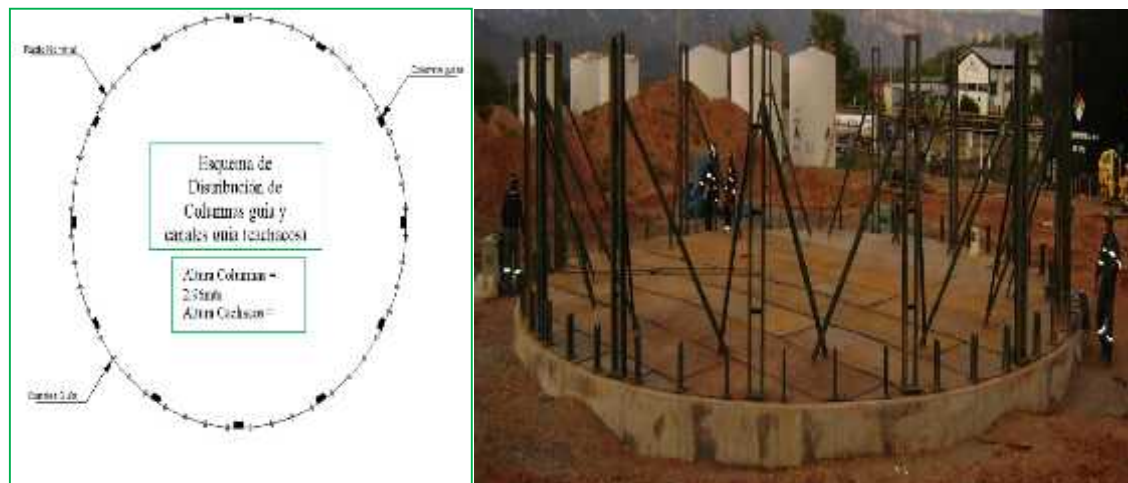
Armado de columnas apoyo y cachacos de sistema de gateo ⁷⁰
